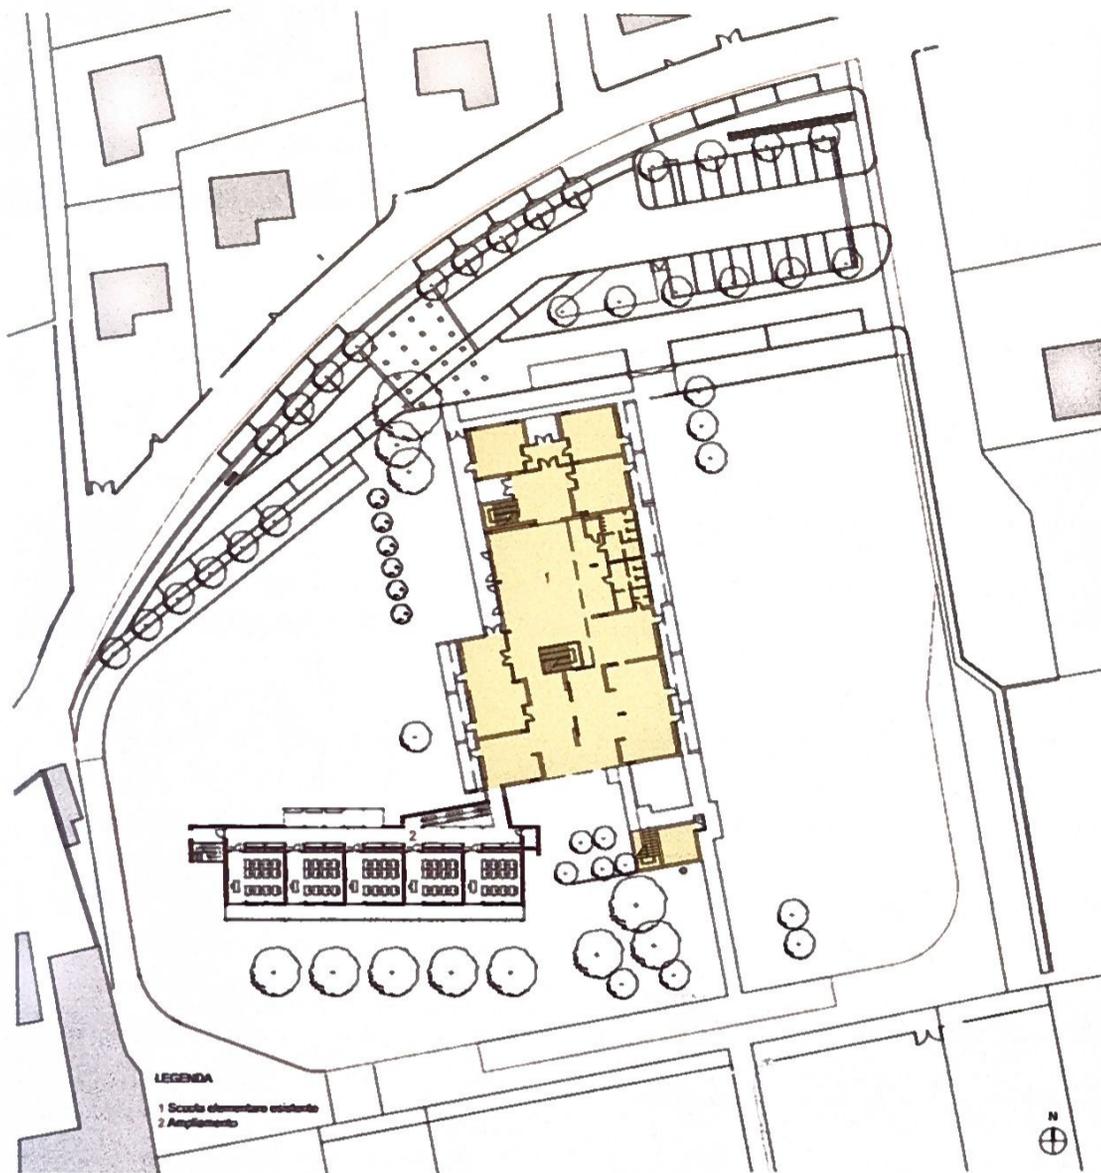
Planimetria generale: in giallo la scuola elementare esistente.
